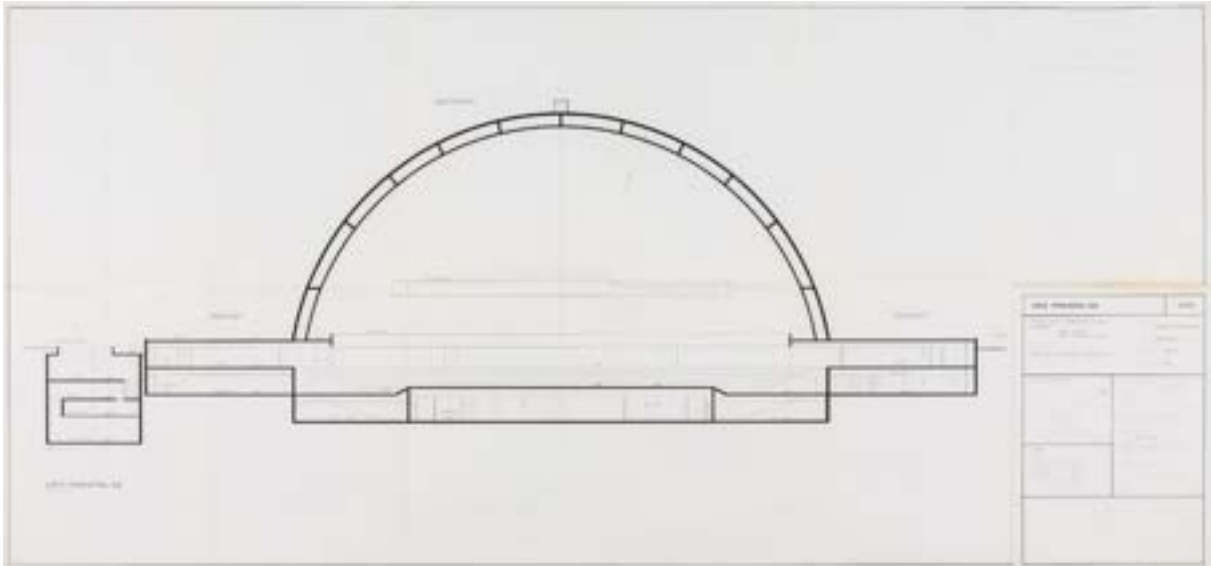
Projeto de aprovação – Corte transversais – foto Rafael Schimidt – fonte: Acervo do DEPAVE
